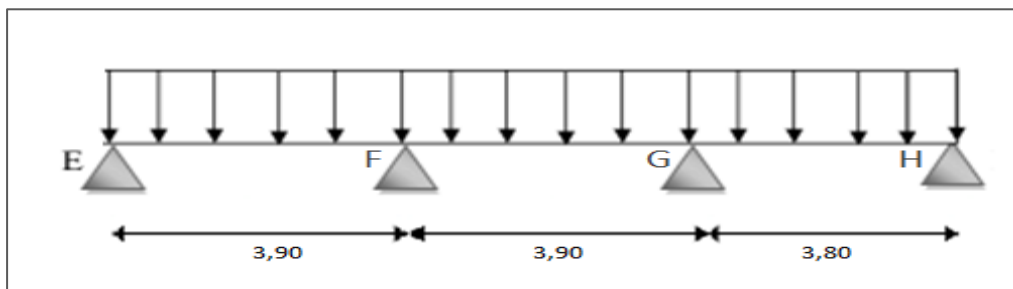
schéma statique de la poutrelle à 3 travées.
